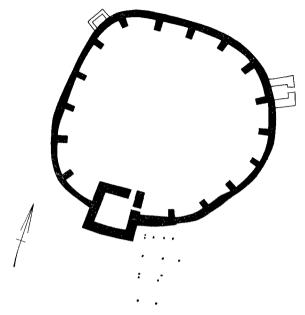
Plan du château d'Egmond, d'après les fouilles; début du xiie siècle; on a consolidé les fondations
